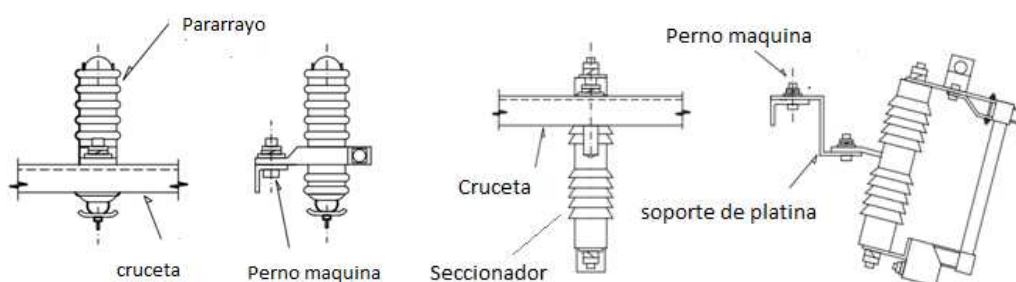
Montaje del seccionador y pararrayo en la cruceta
